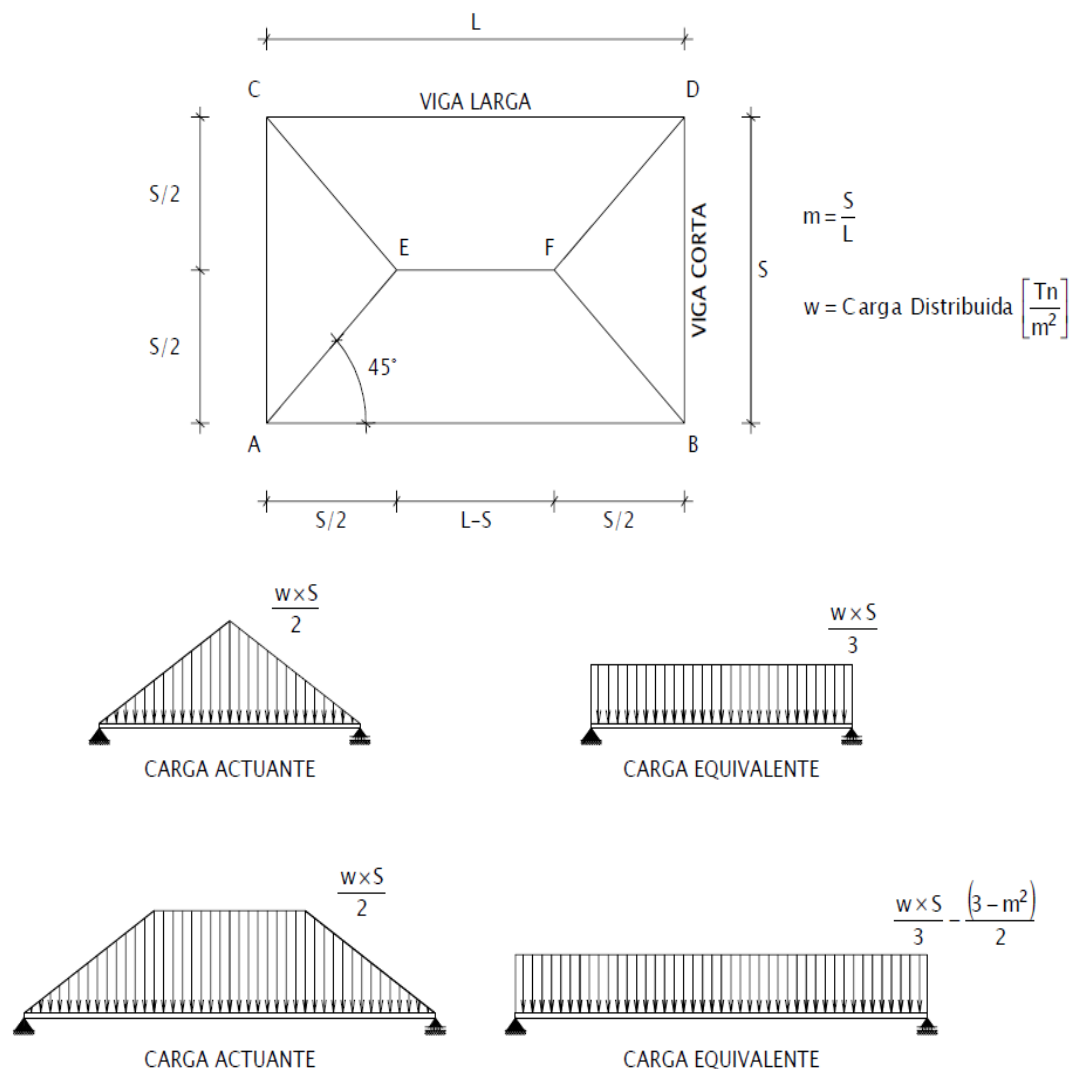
Análisis de cargas para vigas. Fuente: Guía para análisis y diseño estructural de edificios de hormigón armado. Elaborado por: Marco Benalcázar
